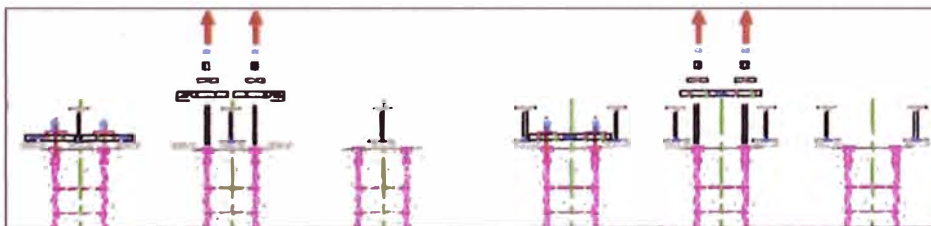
Vista sección de colocación de anclajes de los carriles de avance.
